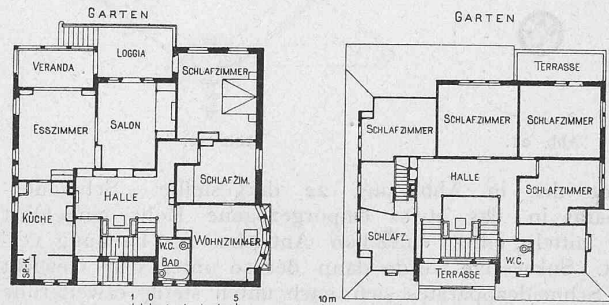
Grundrisse vom Erdgeschoss und Dachgeschoss. — 1:400.
